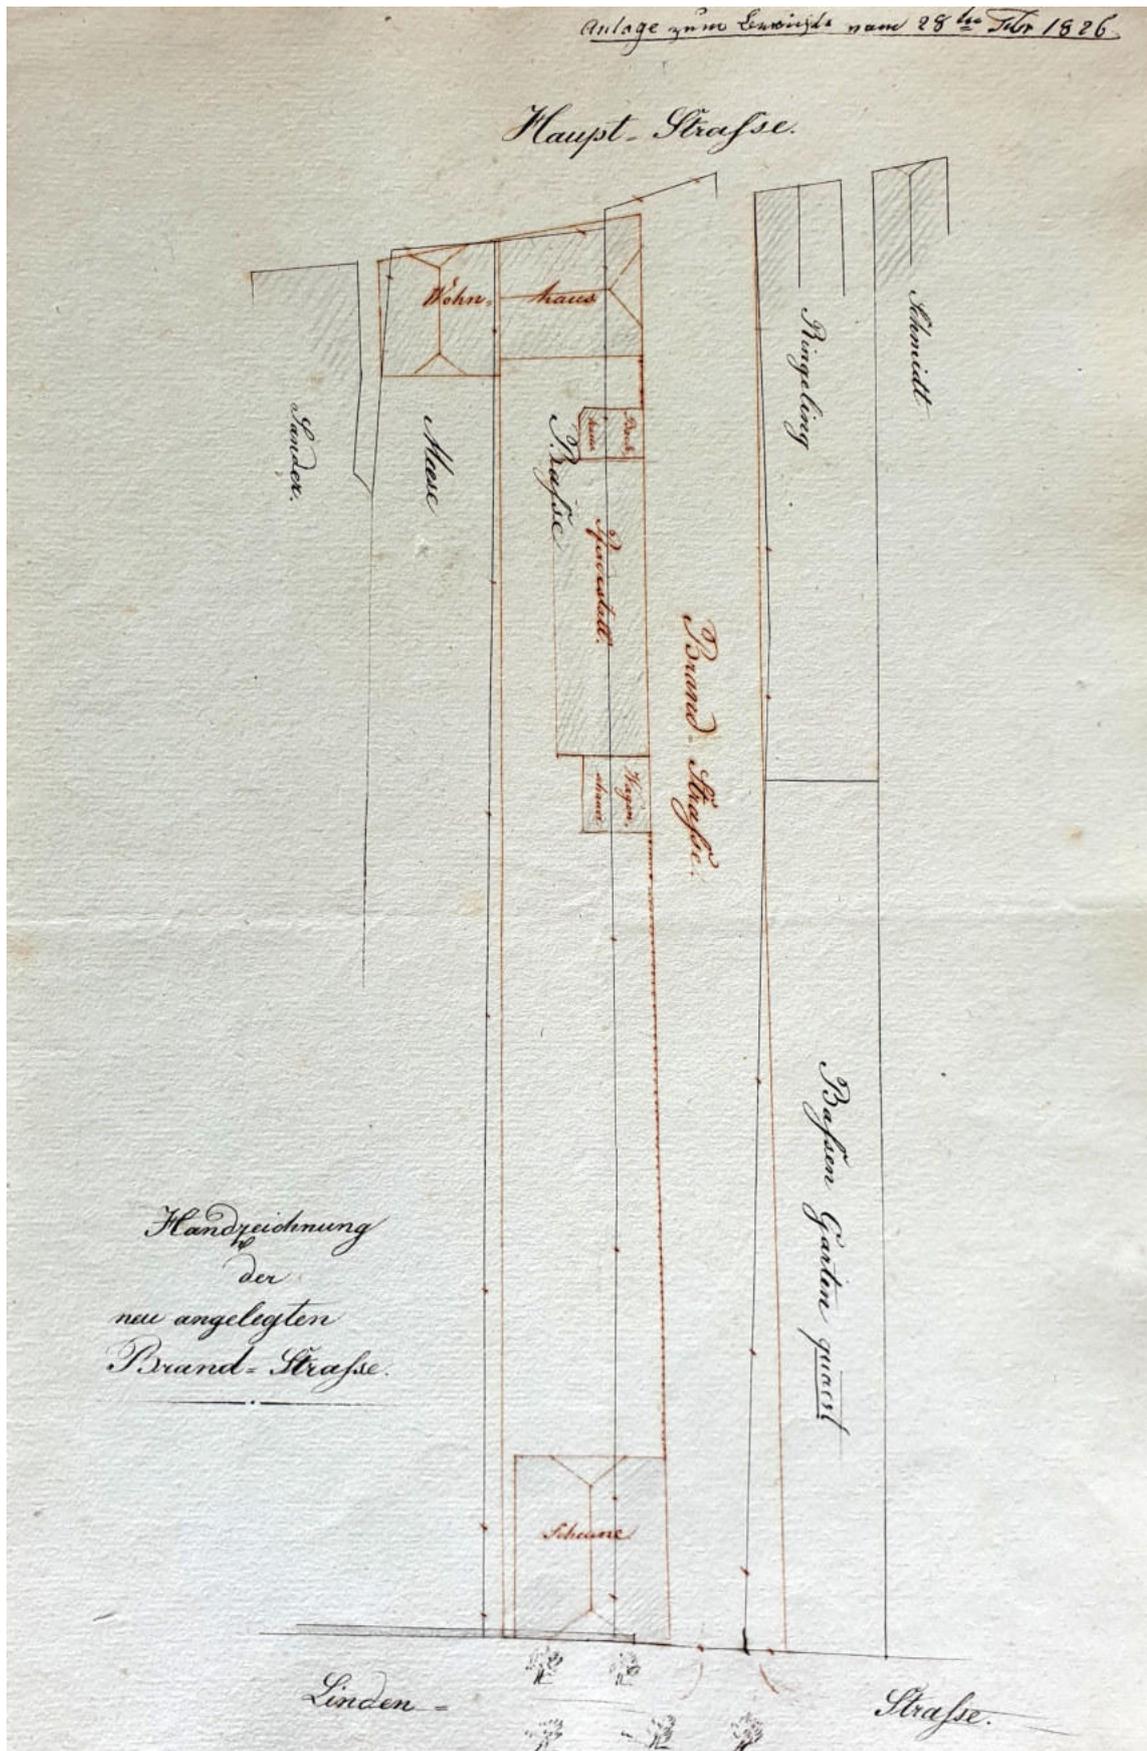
Lageplan für die im Rahmen des Wiederaufbaus neu angelegte Brandstraße mit dem damals über die gesamte Länge der Brandstraße verlaufenden Grundstück der heutigen Hauptstraße 24. Darin ist die Neubebauung mit Vorderhaus, Backhaus, Pferdestall, Wagen-schauer und Scheune eingetragen.
